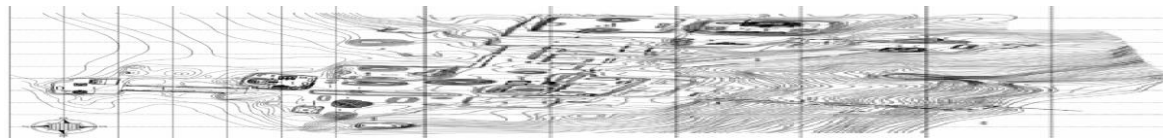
D 26: Segunda Aproximación de la Calzada Lincoln. Vista sureste.
